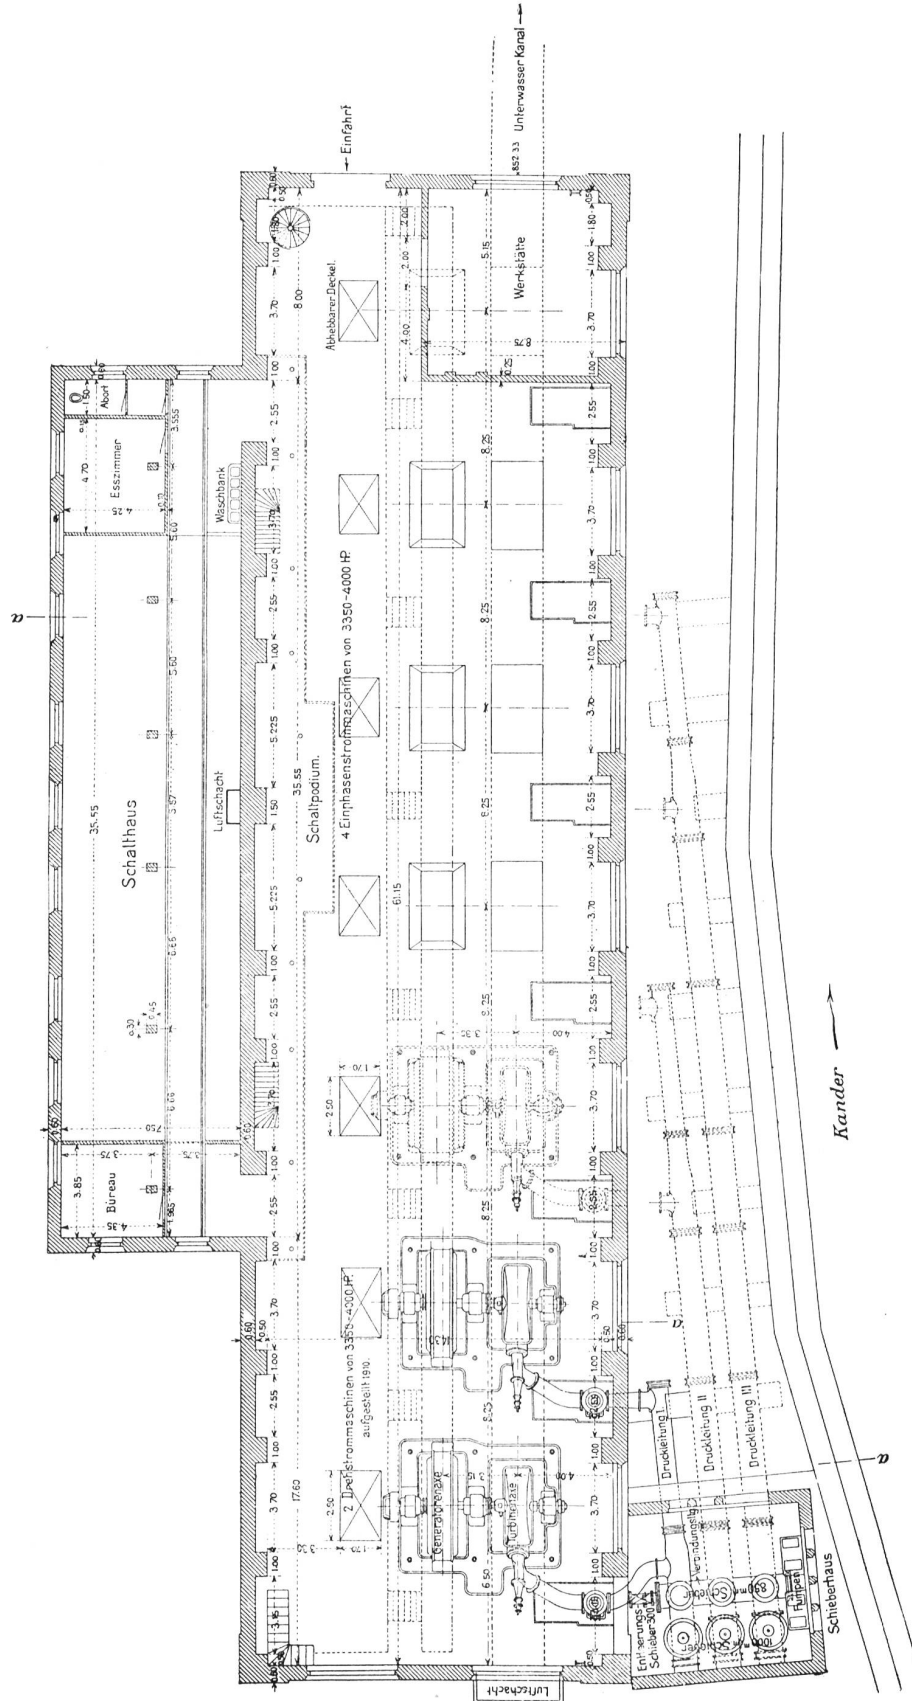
Elektrizitätswerk Kandergondel. Grundriss der Zentrale über dem Parterre. Maßstab 1 : 500.
